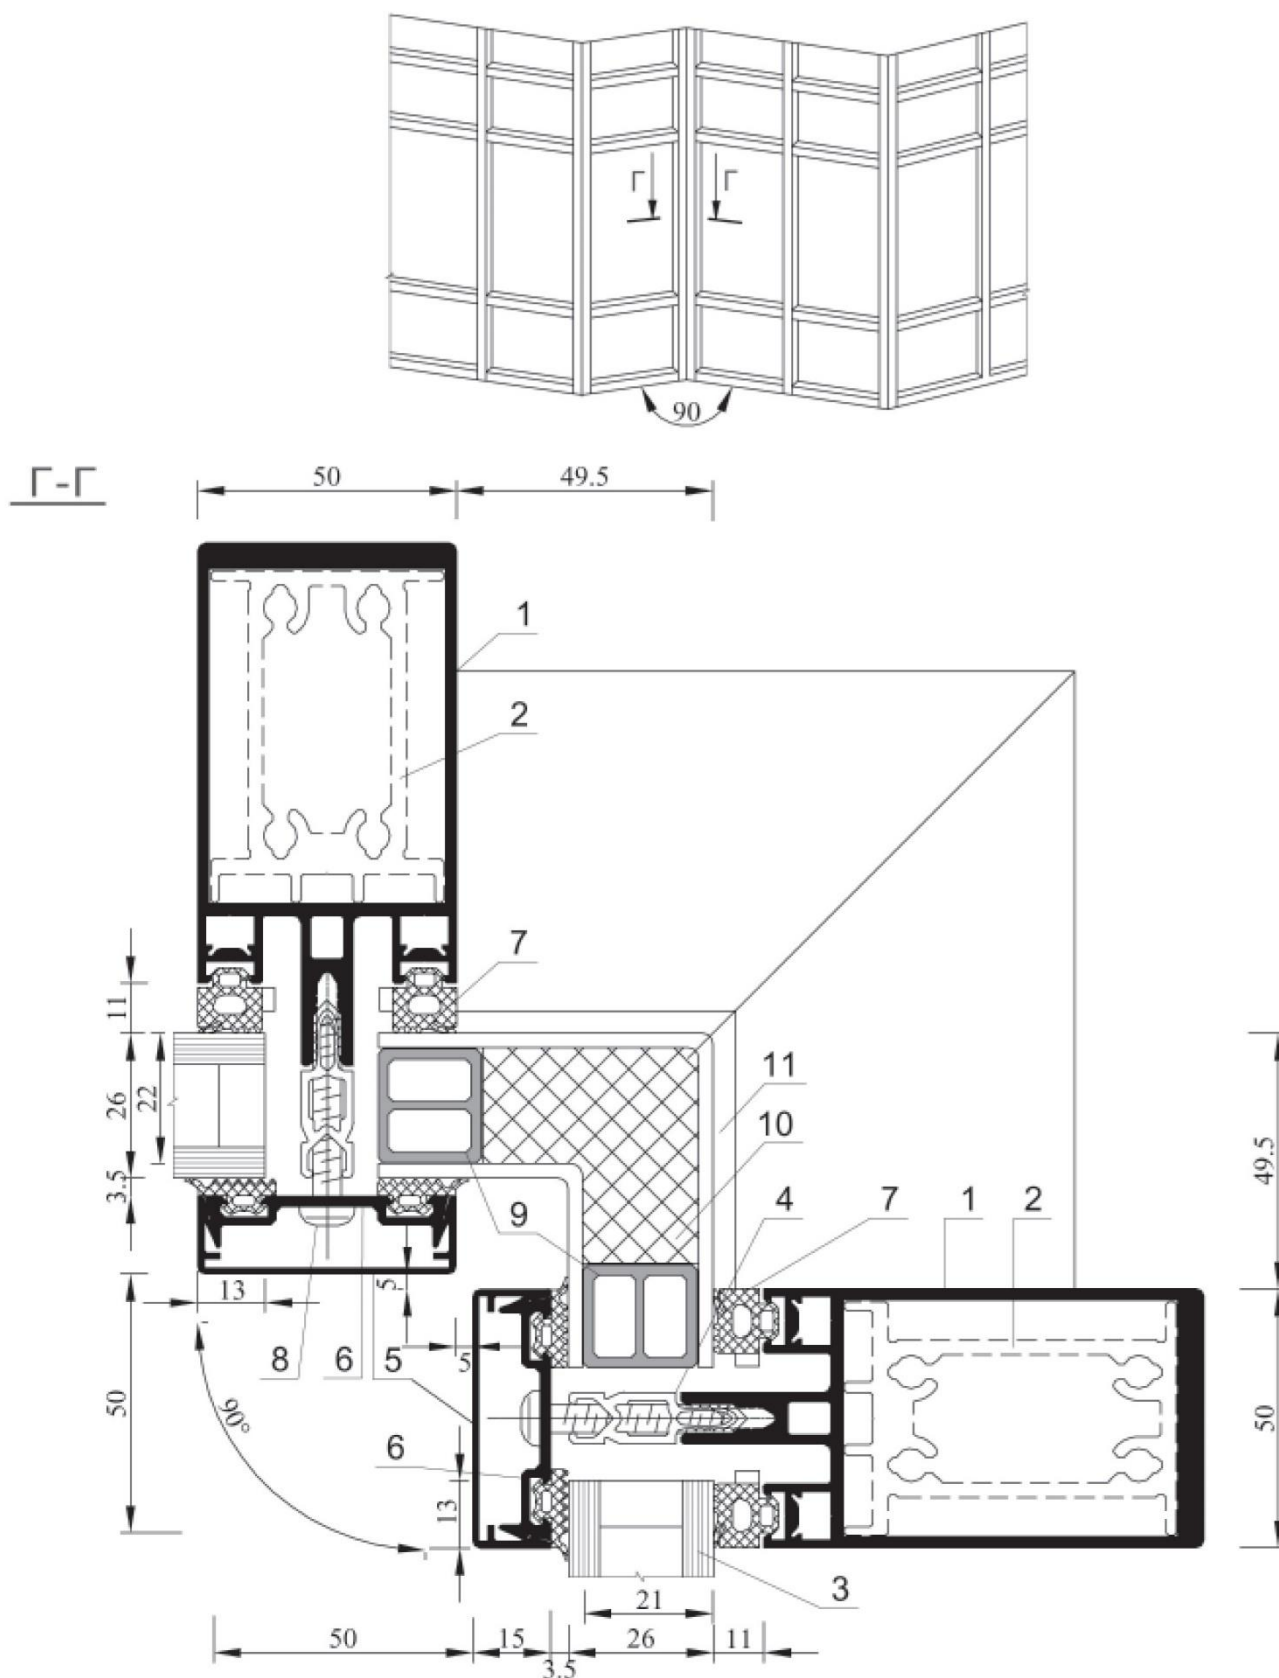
Кутова фасадна накладна конструкція з алюмінію [9]
